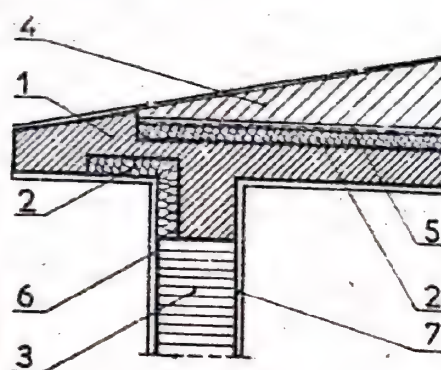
Cornișă cu izolație orizontală exterioară și verticală a centurii; 1-Beton armat; 2- Izolație termică; 3- Zidărie perete; 4- Beton pantă; 5- Mortar de egalizare și rabiț; 6- Tencuială exterioară; 7- Tencuială interioară.
